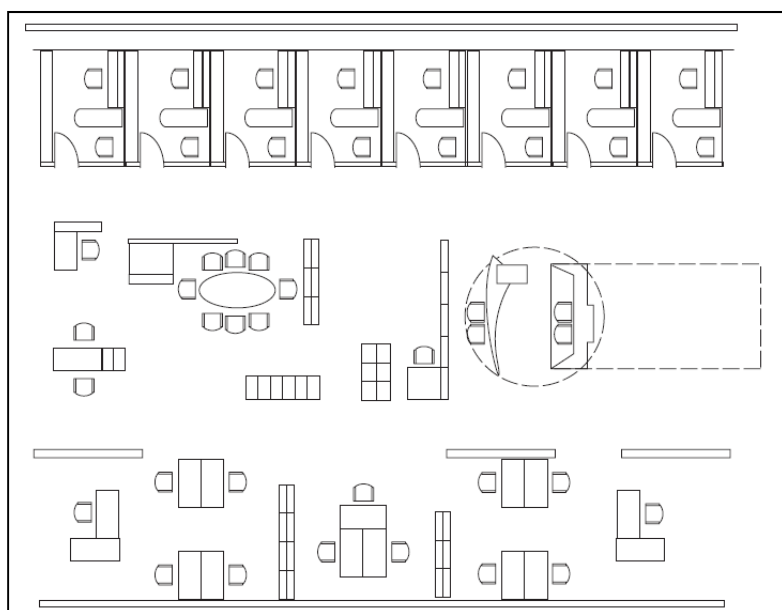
Beispiel für den Grundriss eines Kombibüros²⁷
